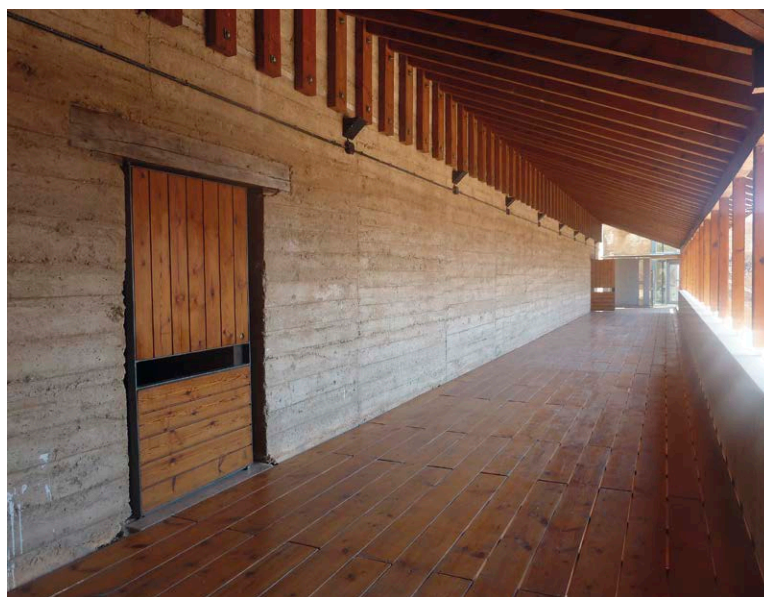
Corredor de acceso en la planta superior del Palacio en el Toral de los Guzmanes (León) (Vegas & Mileto) donde se puede observar la textura del muro de tapia reconstruido, la cubierta de madera y el elaborado apoyo de las correas de madera en la tapia
